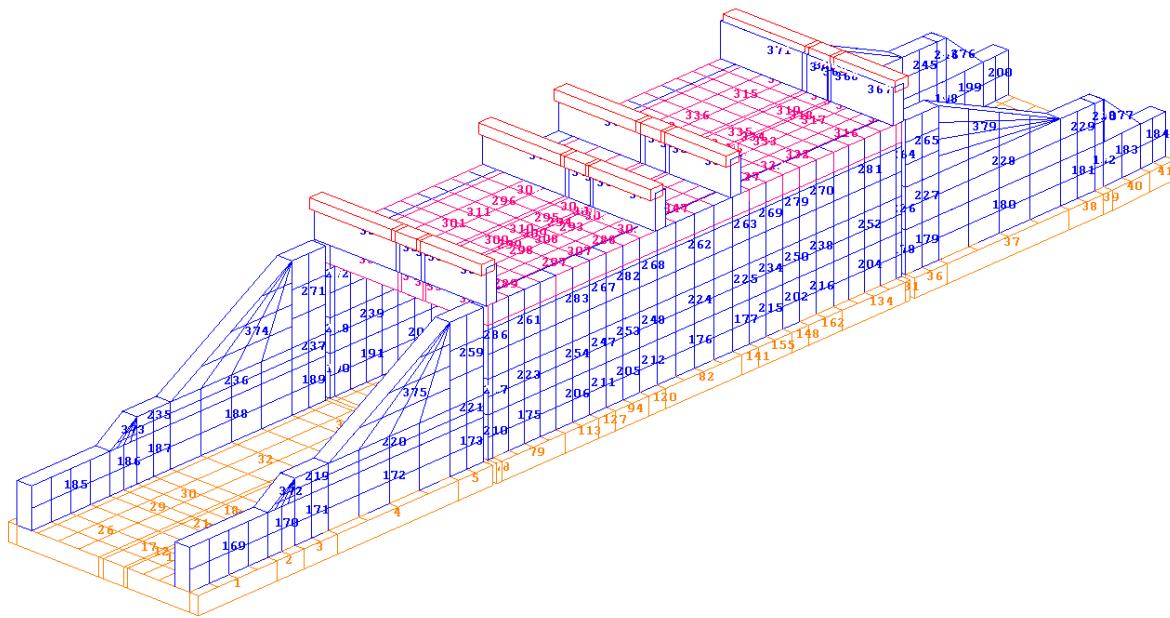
"Vista del modello di calcolo tridimensionale con indicazione del n.ro degli elementi tipo shell"
